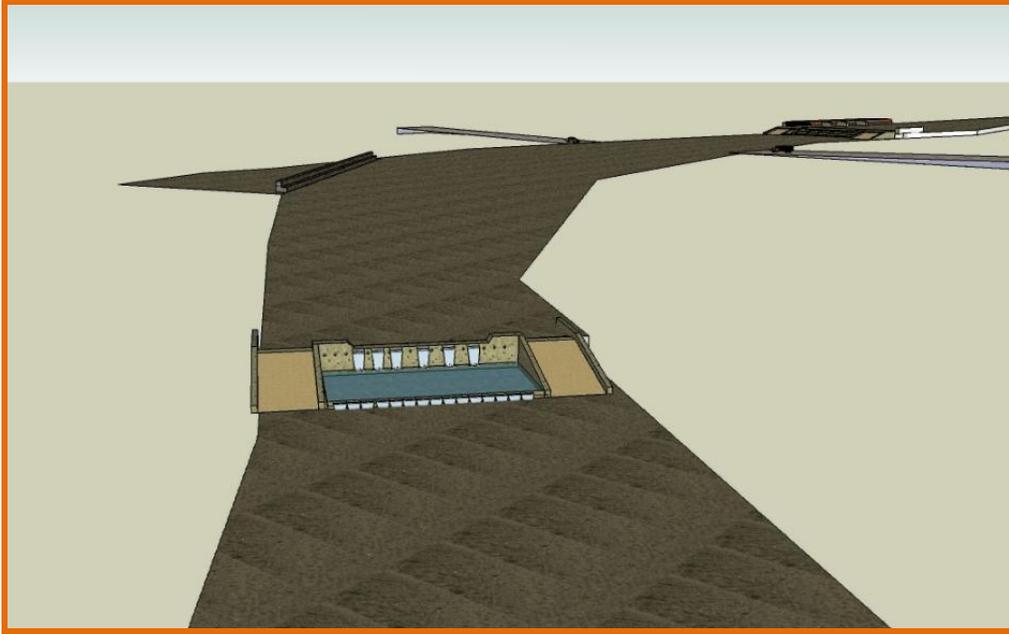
, Vista esquemática de cada una de las obras propuestas en el Tramo N° 2
